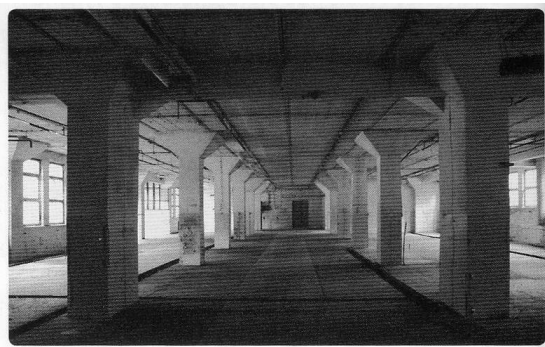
ŽB konstrukce přádelny v Plavech F. Brůna; zdroj: archiv VCPD záznam V006703, foto 1908
